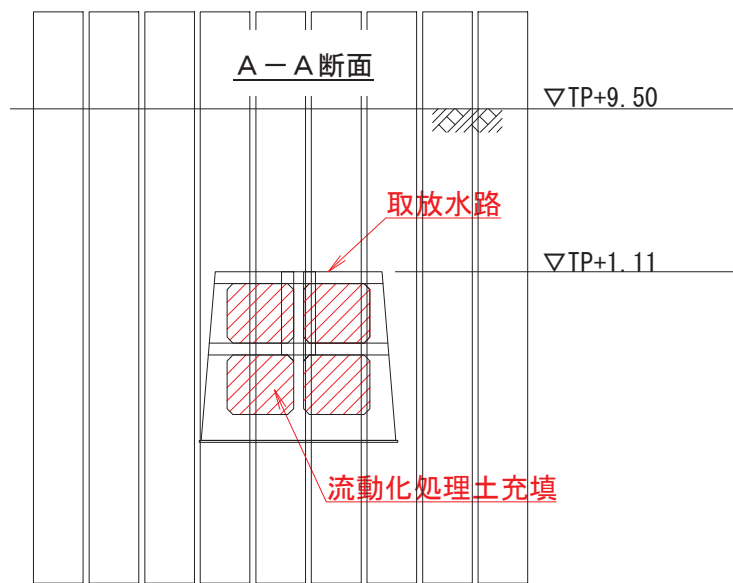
取放水路埋戻し位置断面図（A-A断面）
